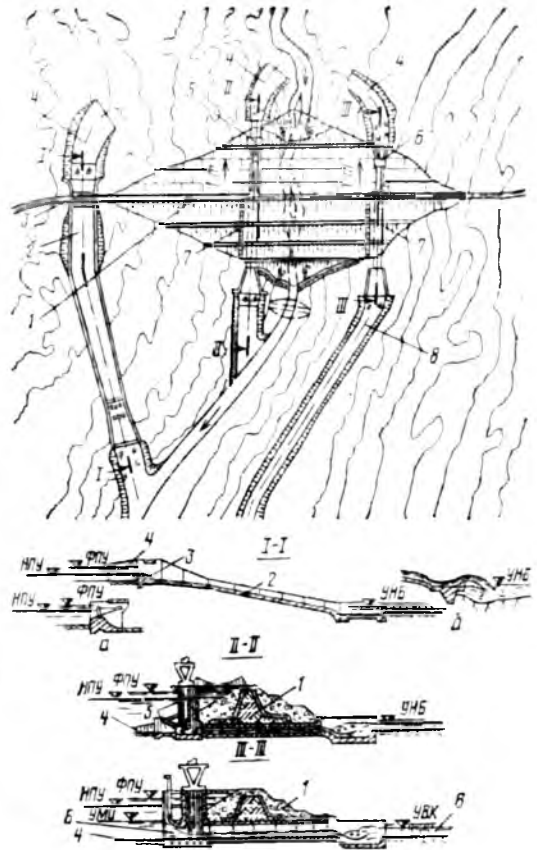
Гидроузел с плотиной из грунтовых материалов и береговым открытым водосбросом:
